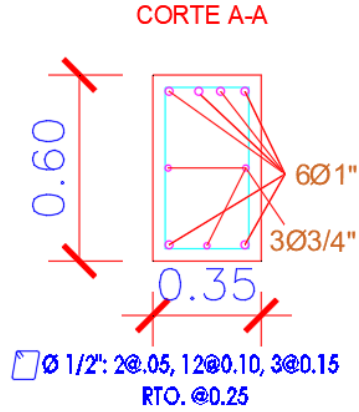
Secciones de Viga con Refuerzo 1° Piso
